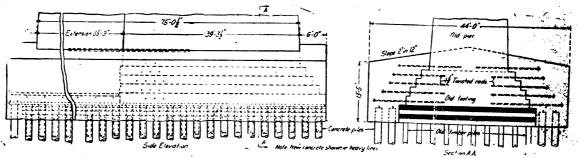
Prolungamento delle pile ed allargamento delle fondazioni esistenti.
